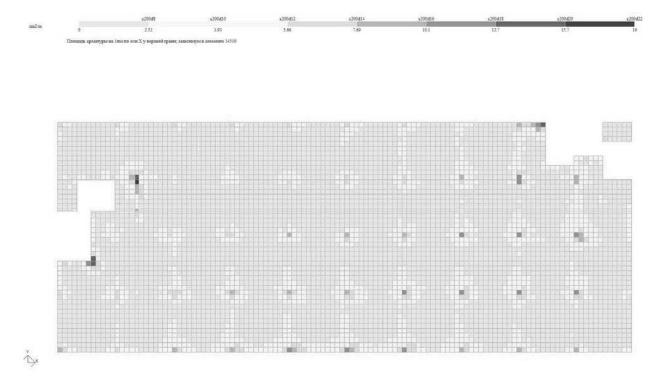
Площадь арматуры вдоль буквенных осей верхней зоны
